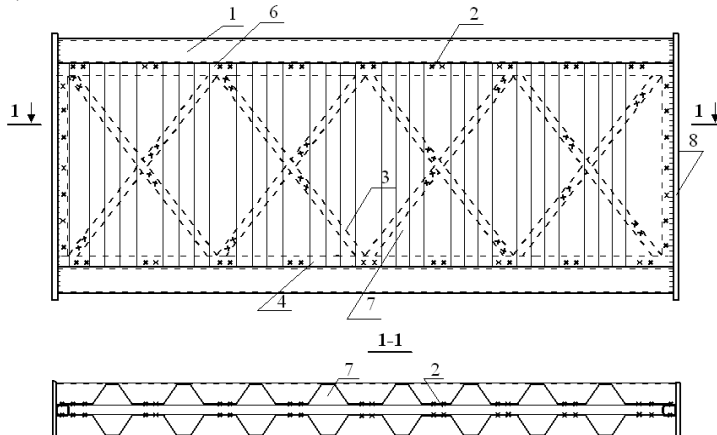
Сталева балка з подвійною поперечно профільованою стінкою, розкріплена хрестовою решіткою: а – вихідна заготовка; б – готовий відсік
